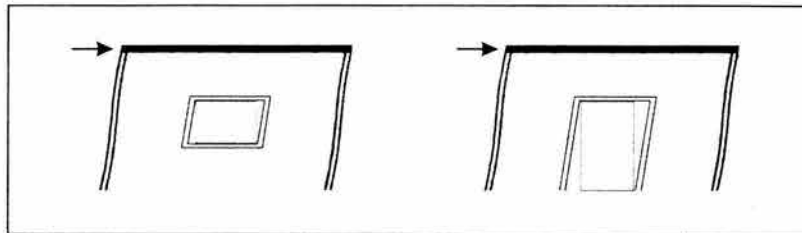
Colocación de muro divisorio en la estructura.
